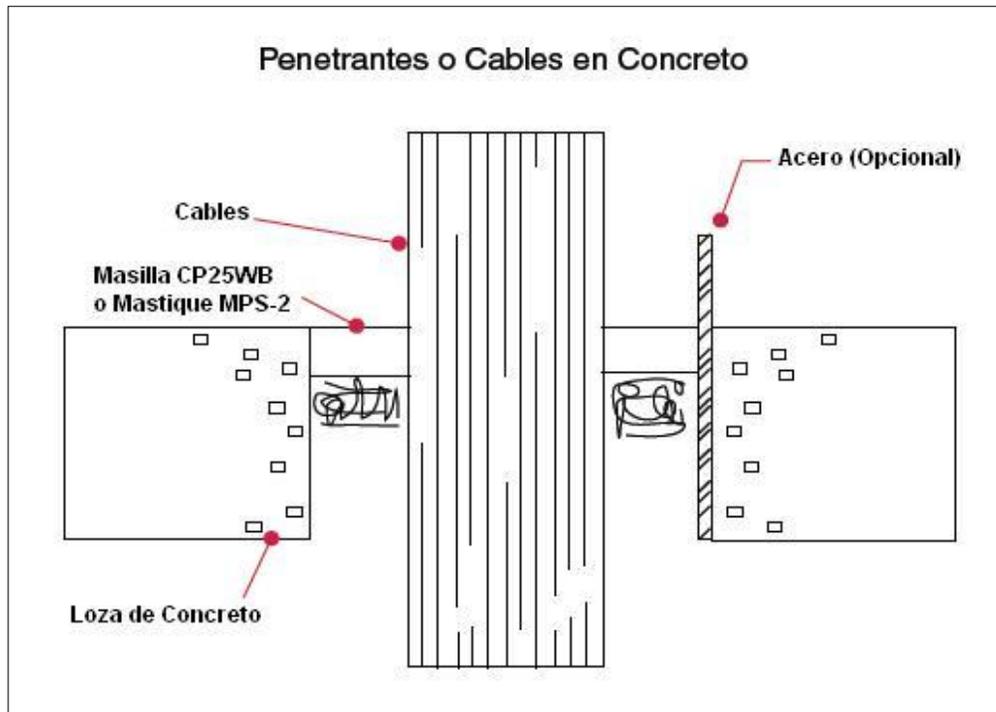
Detalle de instalación de Penetrantes o cables a través de una losa de concreto.
